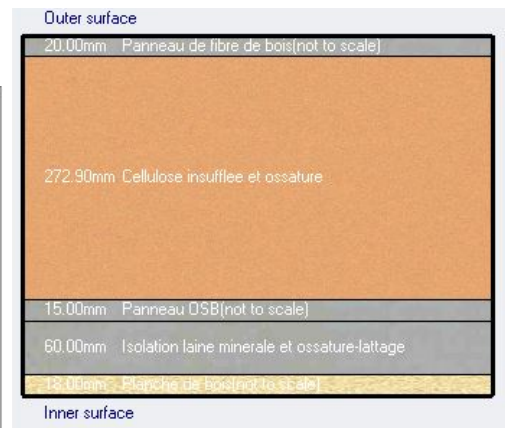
DesignBuilder - Construction – Mur de séparation avec le Garage – Illustration
